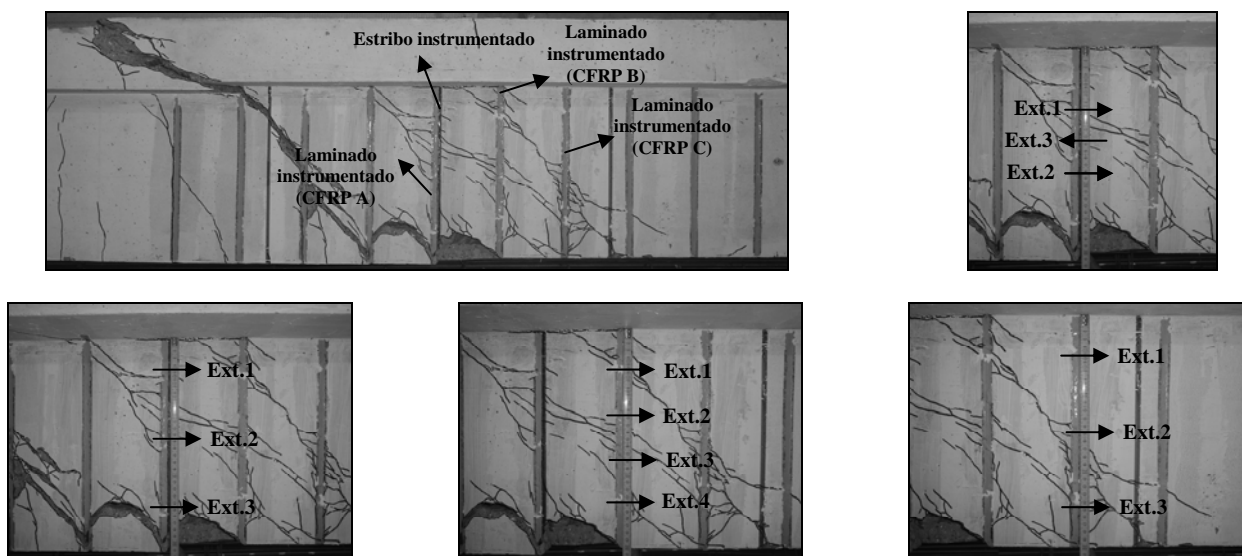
Localização dos extensômetros no laminado e estribo instrumentados da viga 3S-10LV-D.
